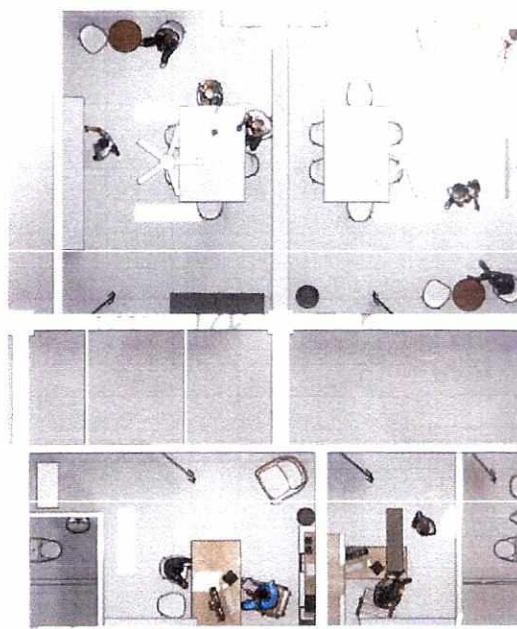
VISTA AÉREA EN 3D DEL ÁREA DE LA INTERVENCIÓN PABELLÓN 1 (LADO B)
